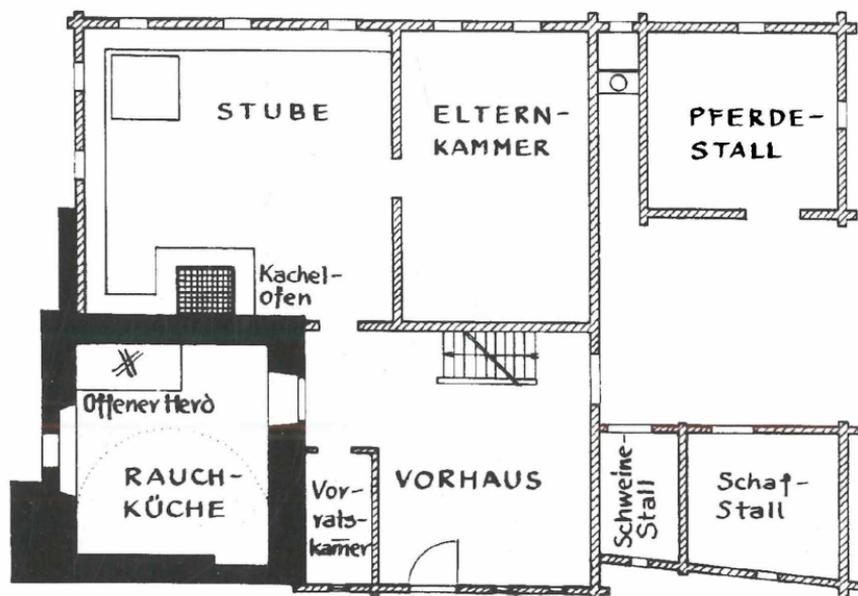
Erdgeschoß-Grundriss des Lärchenhofes ab 1875.
